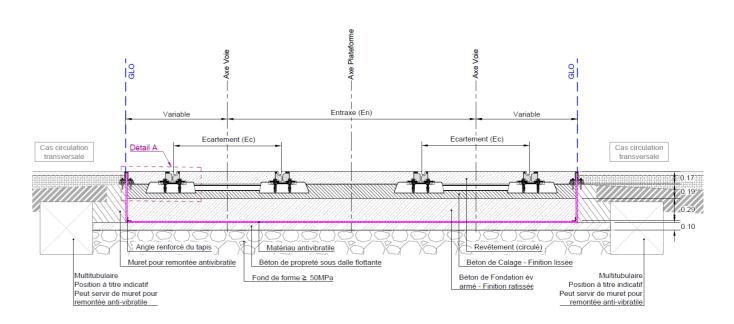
coupe type d'une plateforme - Voie béton traverses – Dalle flottante
